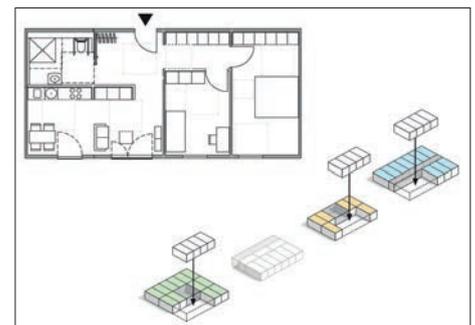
Typengrundrisse für unterschiedliche Bauformen und Erschließungssysteme „Bauen mit Weitblick“ – Vortrag 3/2018, Quelle: Markus Lechner, Lehrstuhl für Holzbau und Baukonstruktion
